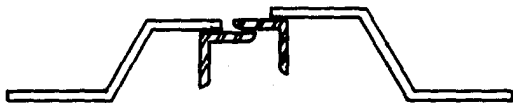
Placas de acero colocadas para tomar la expansión y contracción del concreto en el firme estructural.
